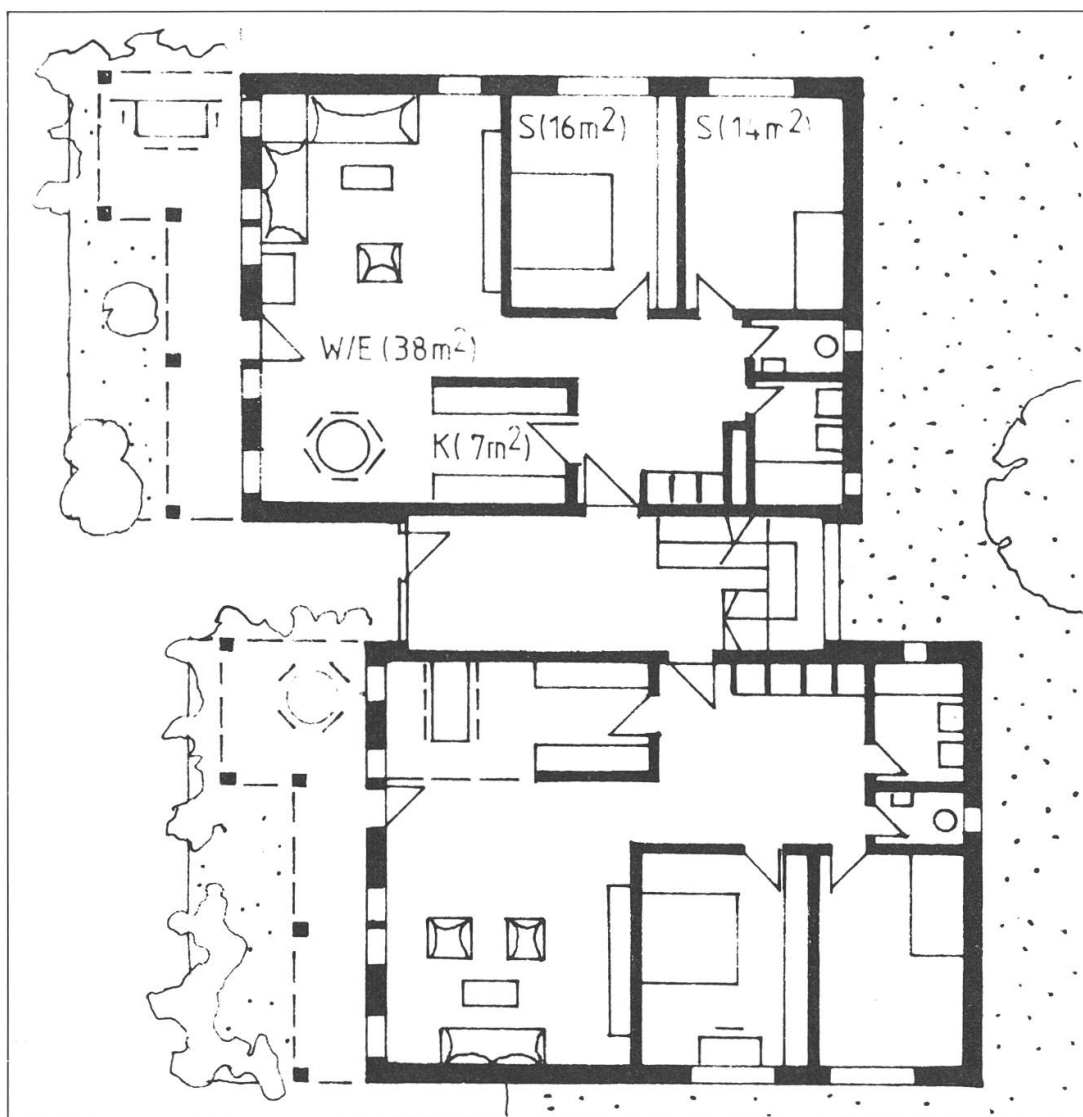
3½-Zimmerwohnung Erdgeschoß laut Vorprojekt mit 90 m²
